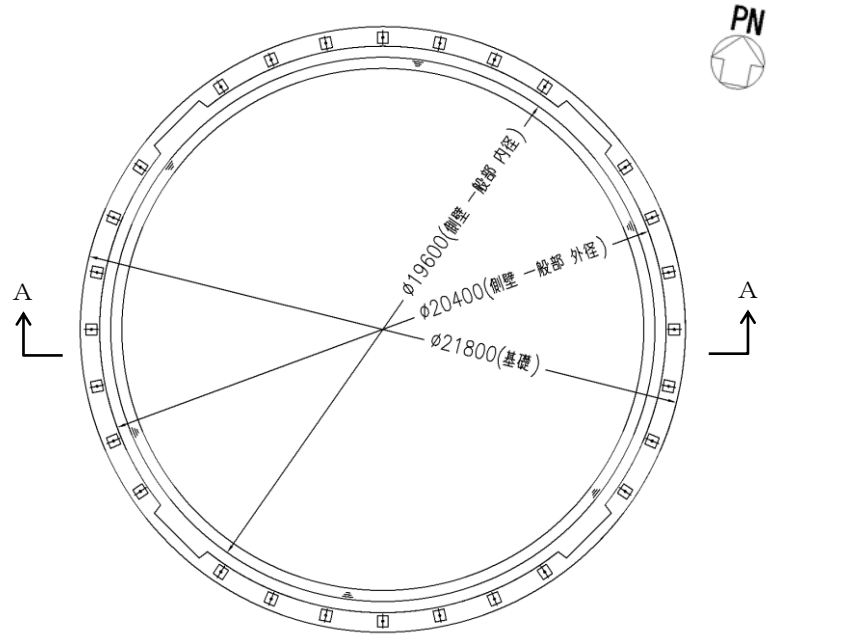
非常用ろ過水タンク 平面図 (単位:mm)
